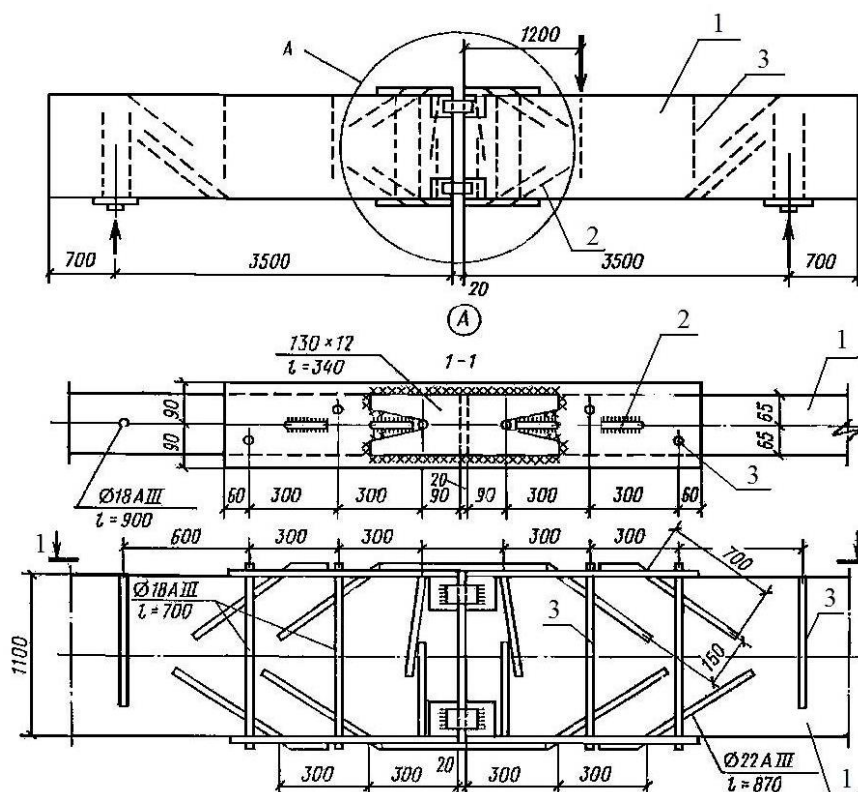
Схема жесткого укрупнительного стыка на наклонных вклеенных стержнях для знакопеременных усилий в изгибаемой конструкции: 1 – клееный элемент; 2 – армирование наклонное; 3 – армирование поперечное; 4 – металлическая пластина-прокладка.
